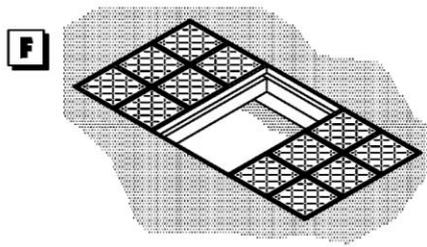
Pemasangan *paver glass block* ke dalam konstruksi
